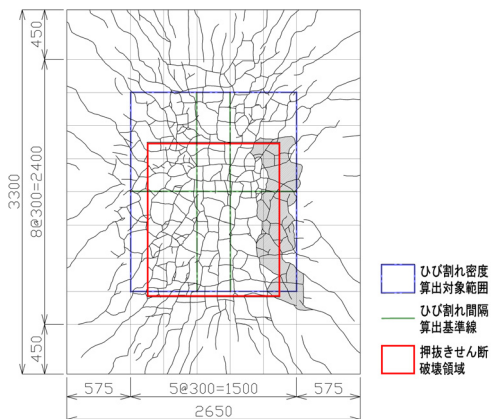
異形鉄筋供試体ひび割れ状況（実験終了時）
